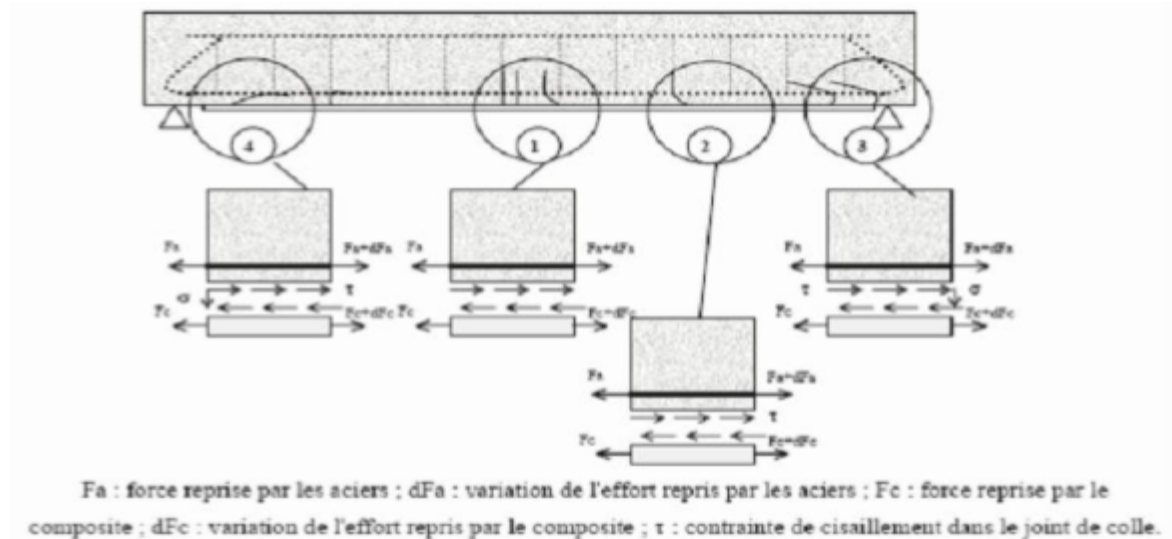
Comportement structural d'une poutre renforcée. [Chedad 2016]
